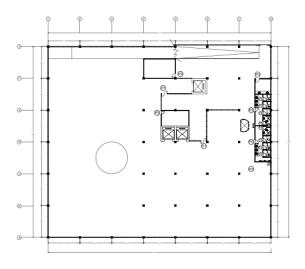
Denah Rencana Pintu Lantai 1 Sumber: dokumen pribadi
